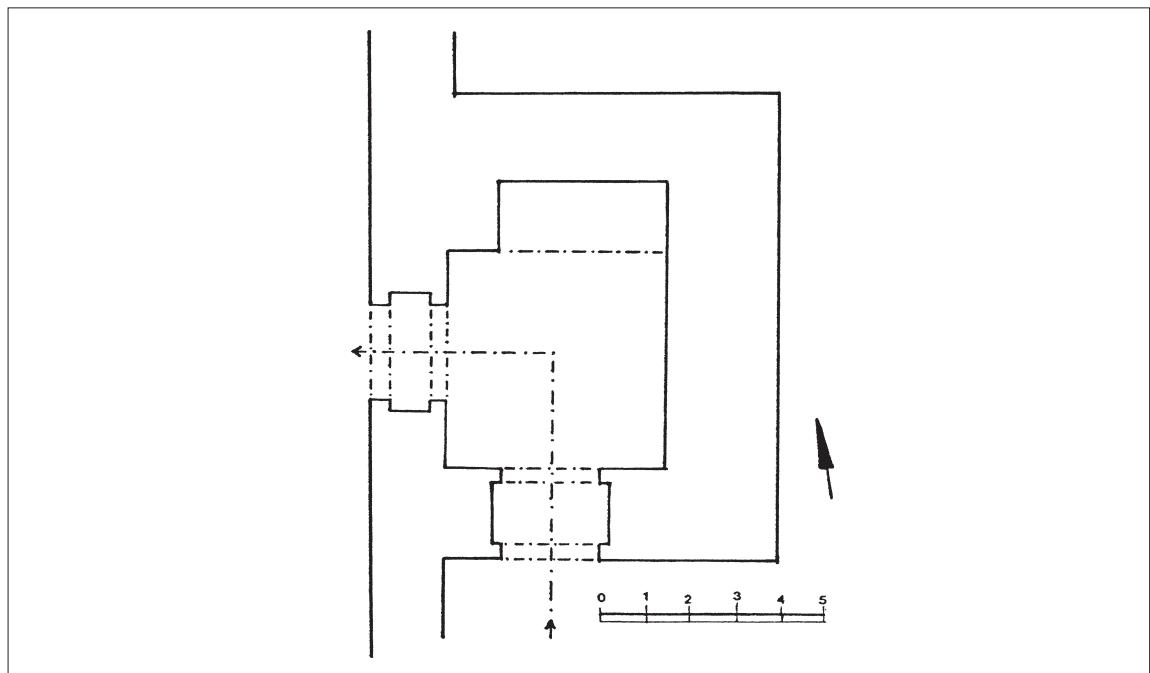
لبلة. باب النجدة، مسقط أفقى. عن (Maldonado .).
